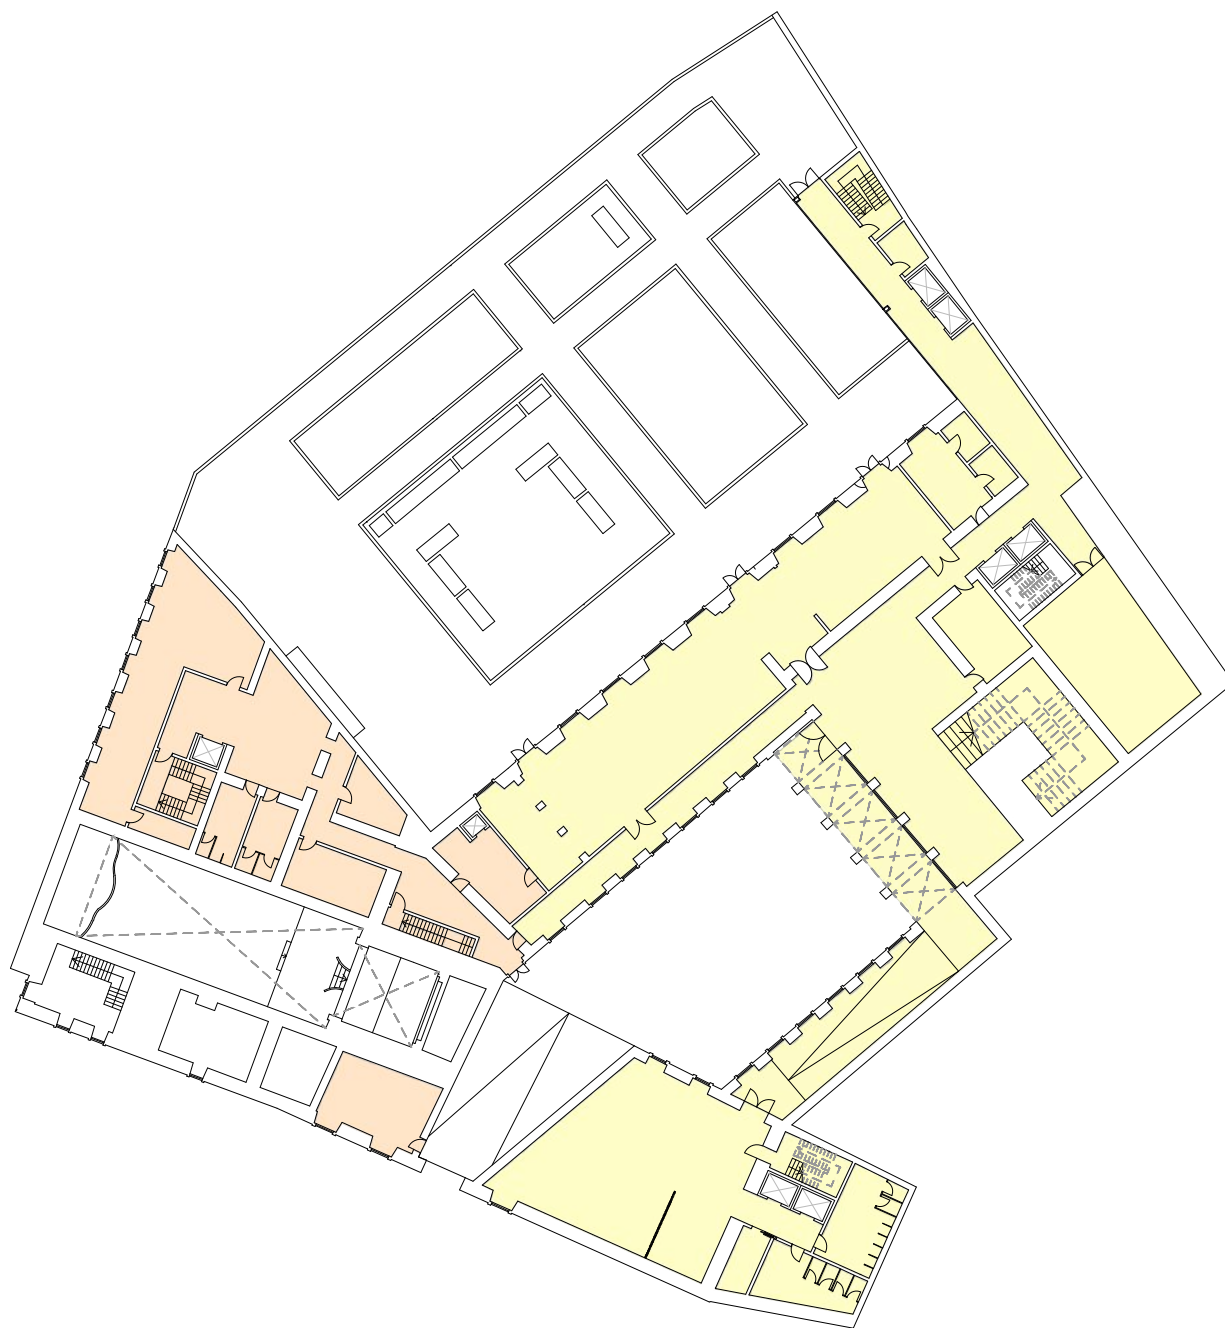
Planta original do piso térreo, à escala 1:500, orientada a Norte
